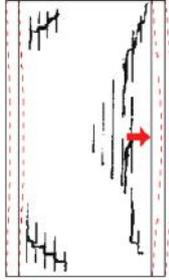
Configuração típica de fissura devido à deformabilidade da estrutura.
